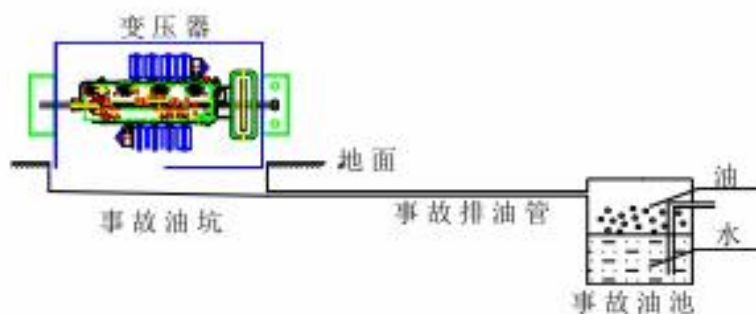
事故油坑、事故排管道及事故油池布置平面图（参照同类型布置）
